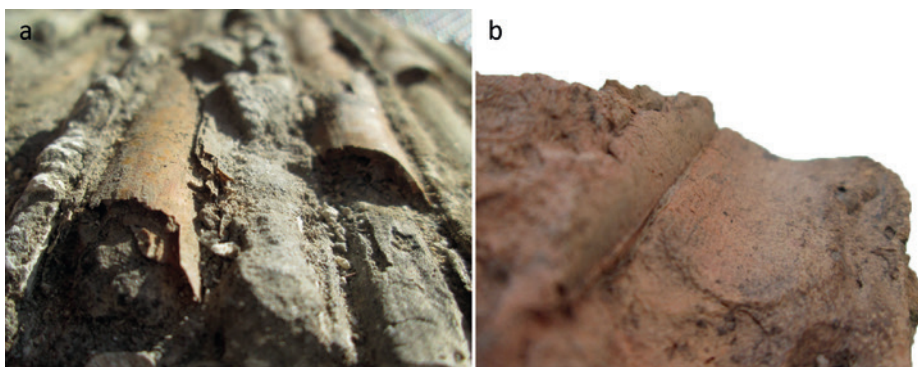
a. Detalle de un resto constructivo de época contemporánea con cañas cortadas por la mitad, generando improntas positivas en el mortero. b. Vista lateral de la cara interna de un fragmento de barro de Cabezo Pardo, con la impronta positiva de caña (izquierda de la imagen). CP 1063/28-5.
